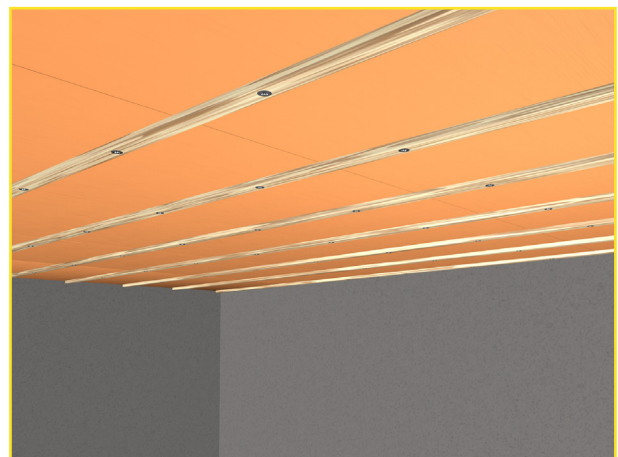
Fixe Befestigung der Bahnen - Entfernen der Hilfsnägeln
